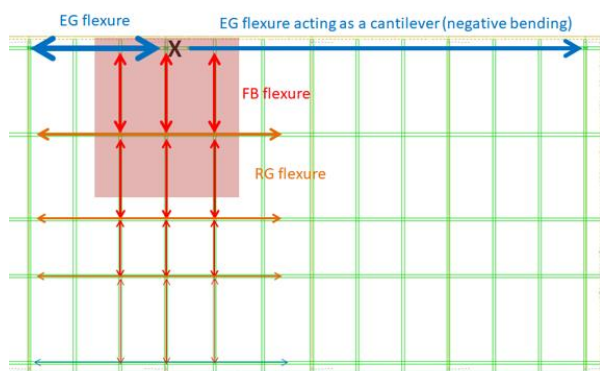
Camino de cargas alternativo – Fractura de viga longitudinal de borde en sección típica
